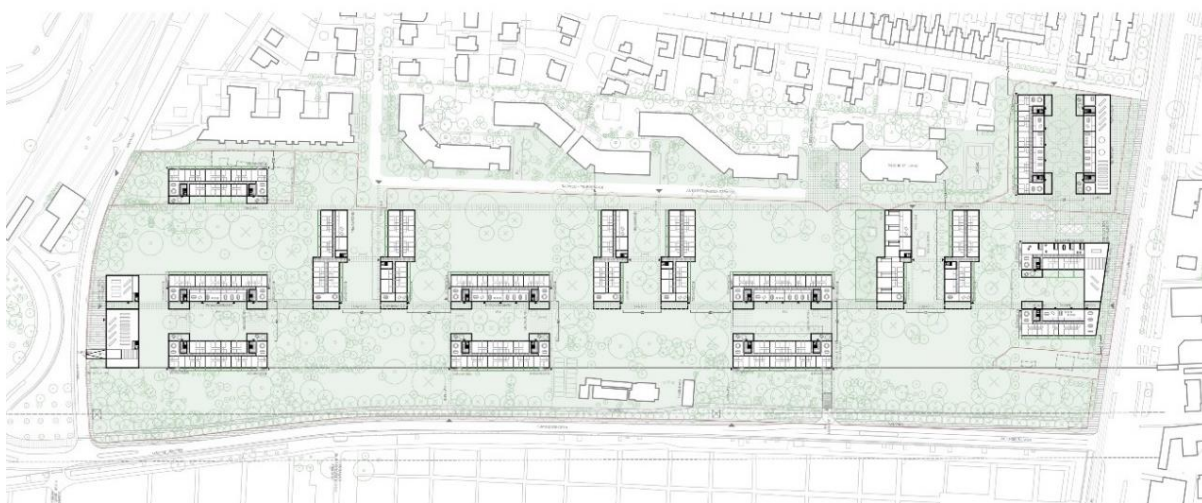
Alternativentwurf B – Lageplan, © Architekt DI Hubert Rieß
